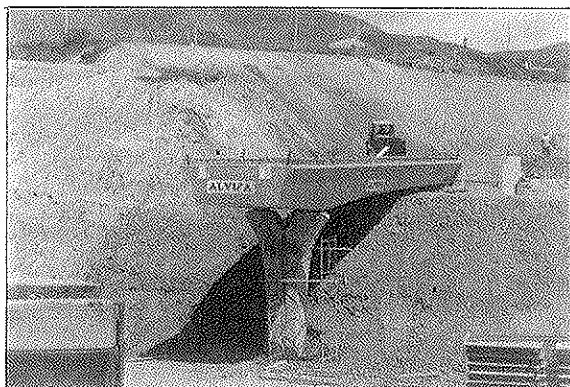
Viga lateral, de trazado parabólico, montada sobre pila prefabricada tipo «Palmera»
